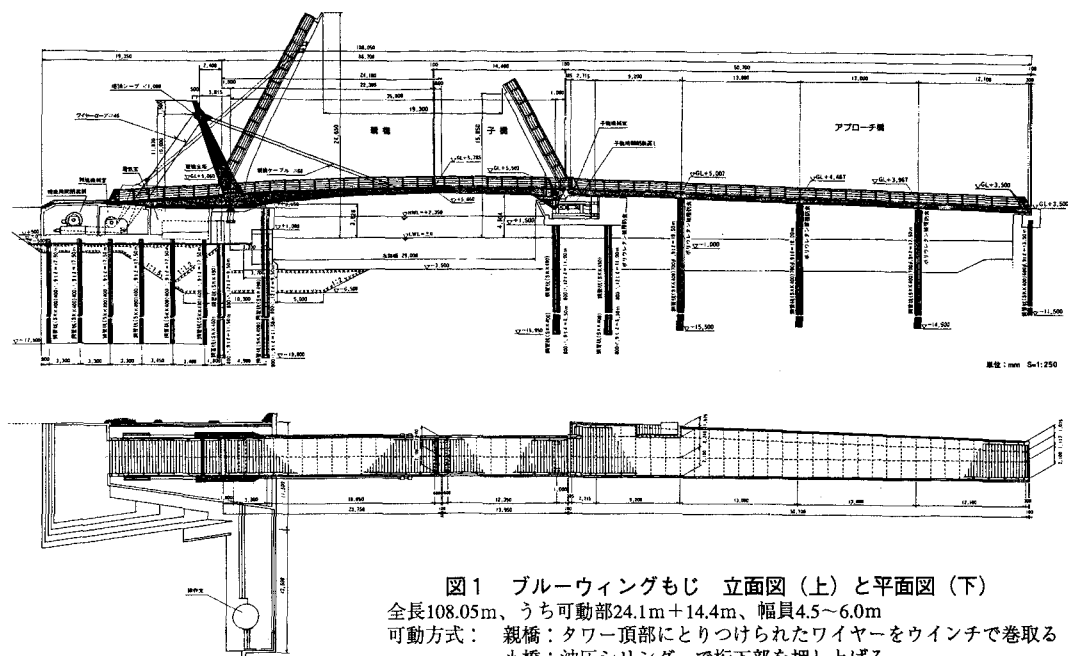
ブルーウィングもじ 立面図（上）と平面図（下）
